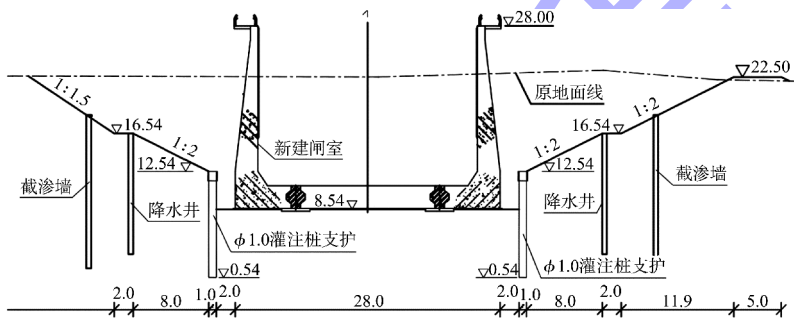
船闸基坑截渗与支护断面布置 (单位: m)
